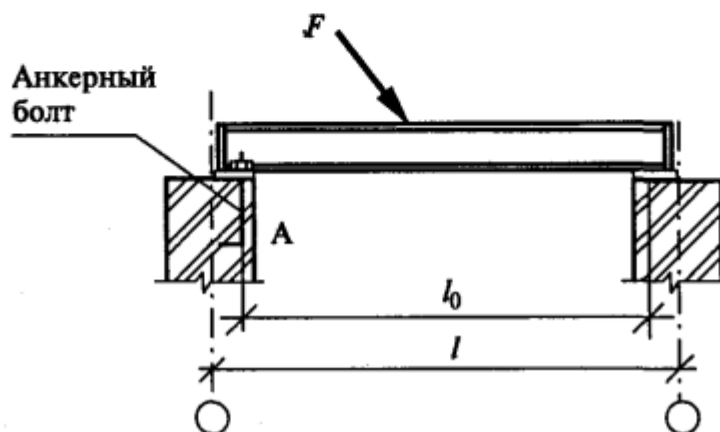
Крепление балки к опоре с помощью анкерного устройства
